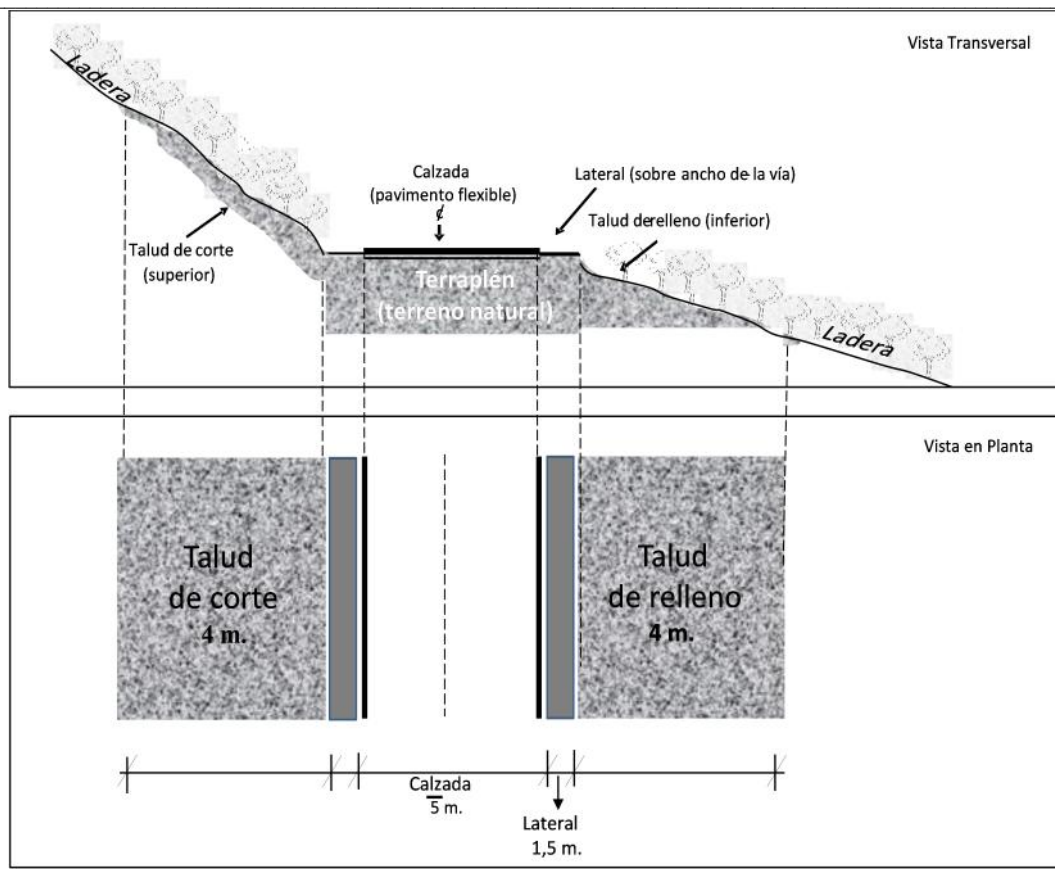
Vista transversal y de Planta del tramo de estudio.
